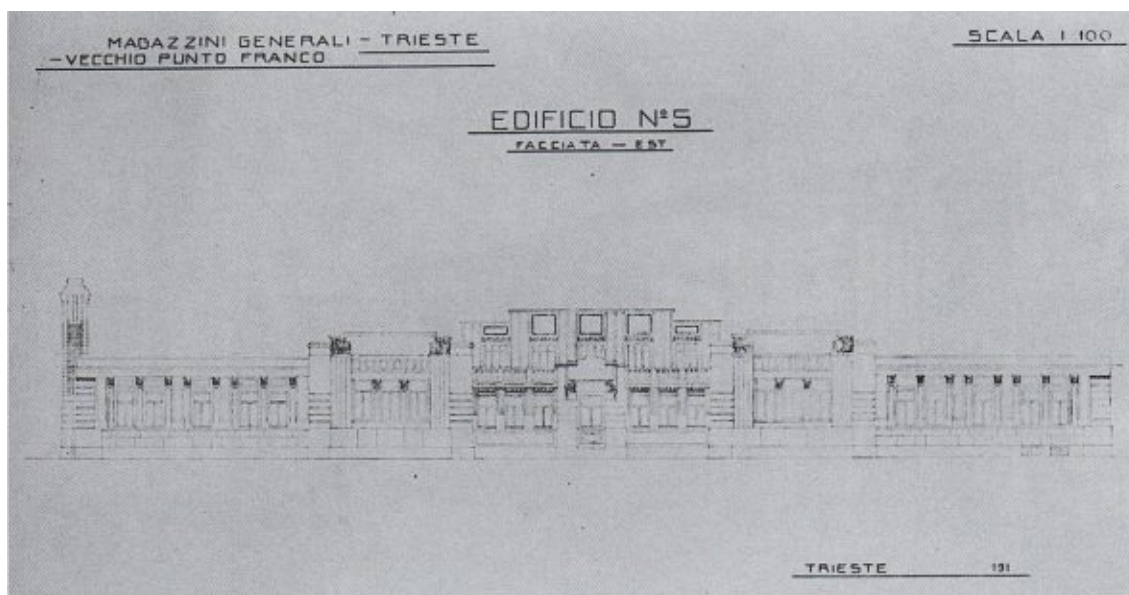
„Locanda“, Ansicht der östlichen Fassade, Giorgio Zaninovich.
